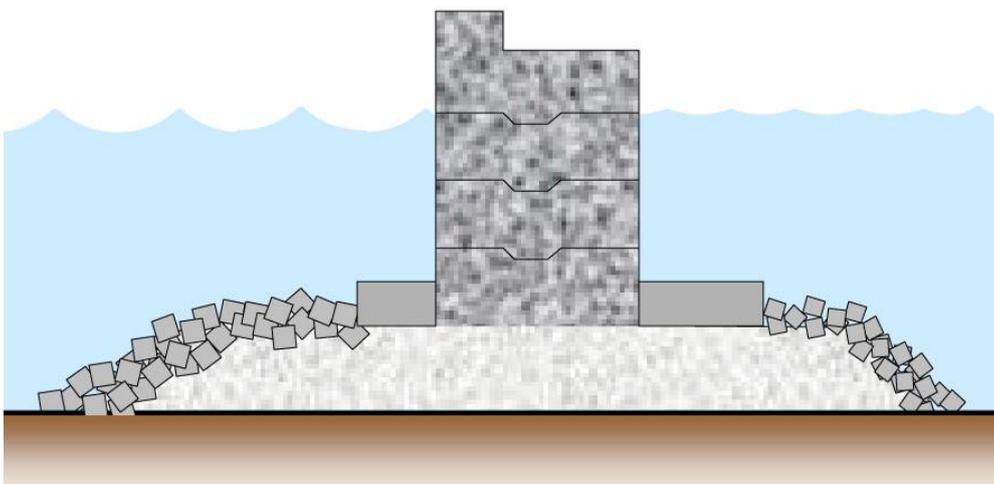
Sección transversal de un dique vertical, en este caso cimentado sobre un fondo de escollera
